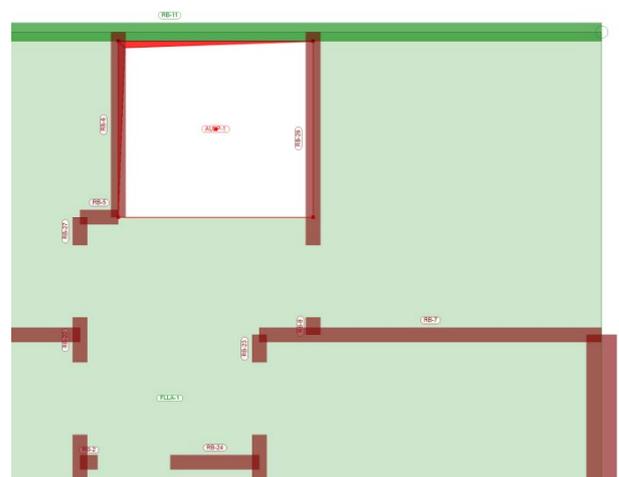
Wandachsen auf Platten- und Aussparungsrand
